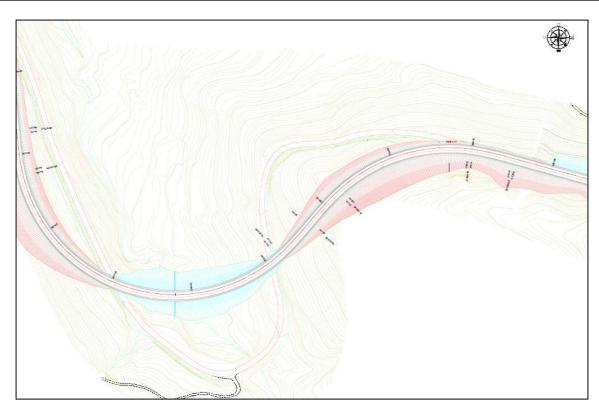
Trazado en planta de un tramo de la Alternativa 2
